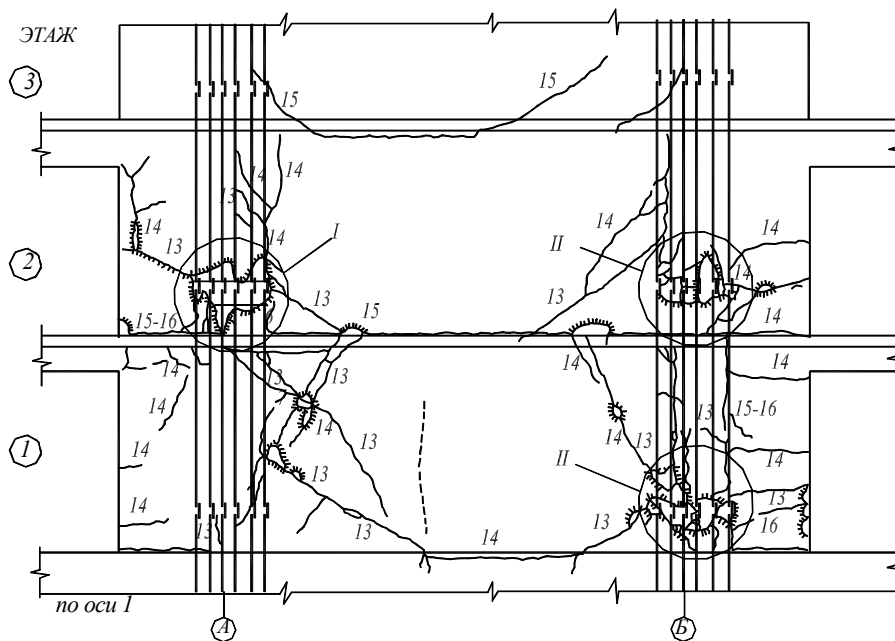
Схема трещинообразования стены фрагмента 2 без полевого армирования (вид снаружи).
